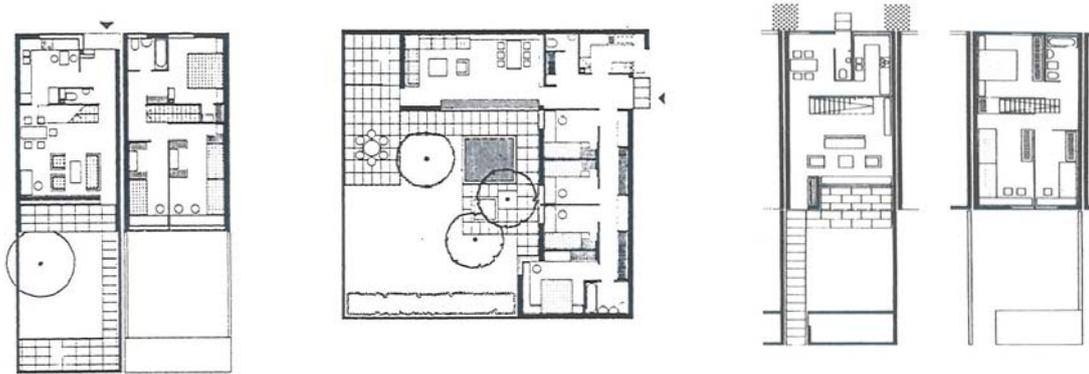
Grundrissvariante Reihenhhaus 4 Zimmer (l)
